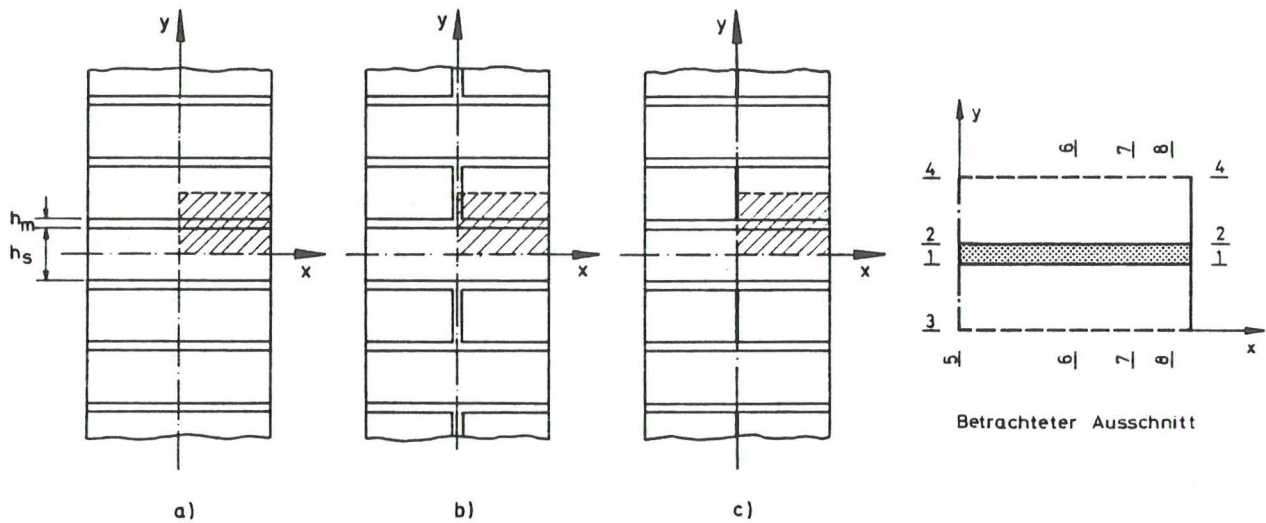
Mauerwerksprisma mit betrachtetem Ausschnitt
